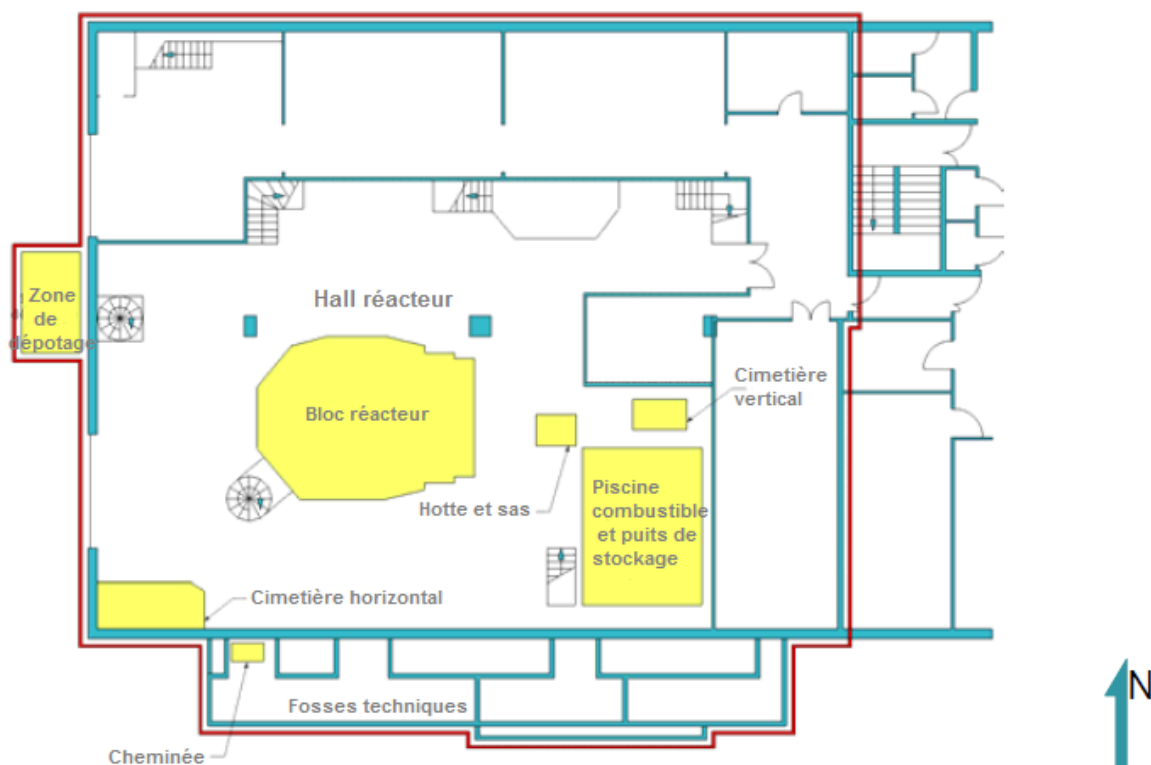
Équipements constitutifs du rez-de-chaussée de l'INB 18
